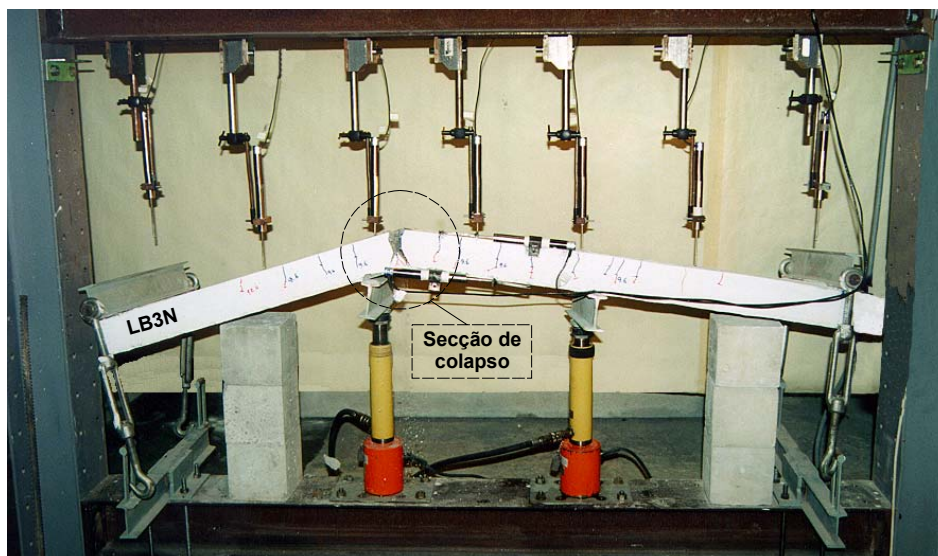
Alçado da laje *LB3N* após o colapso.
